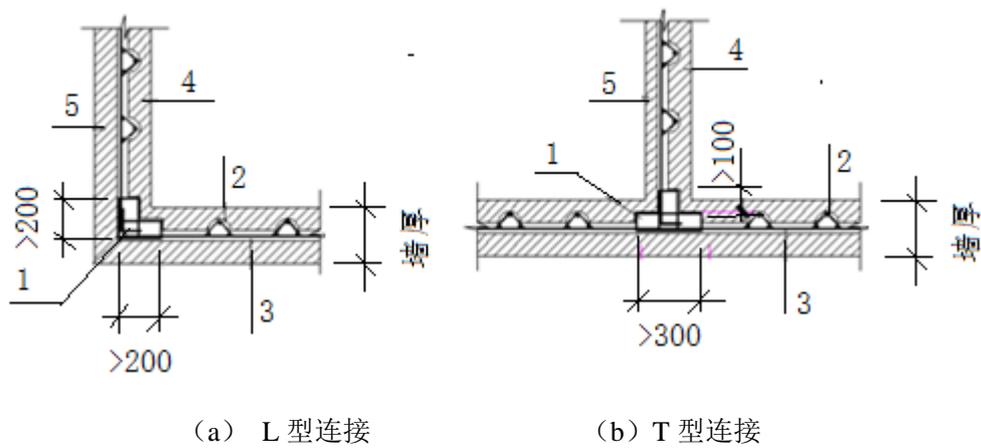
格构式墙边缘构件的形状及配筋示意图
